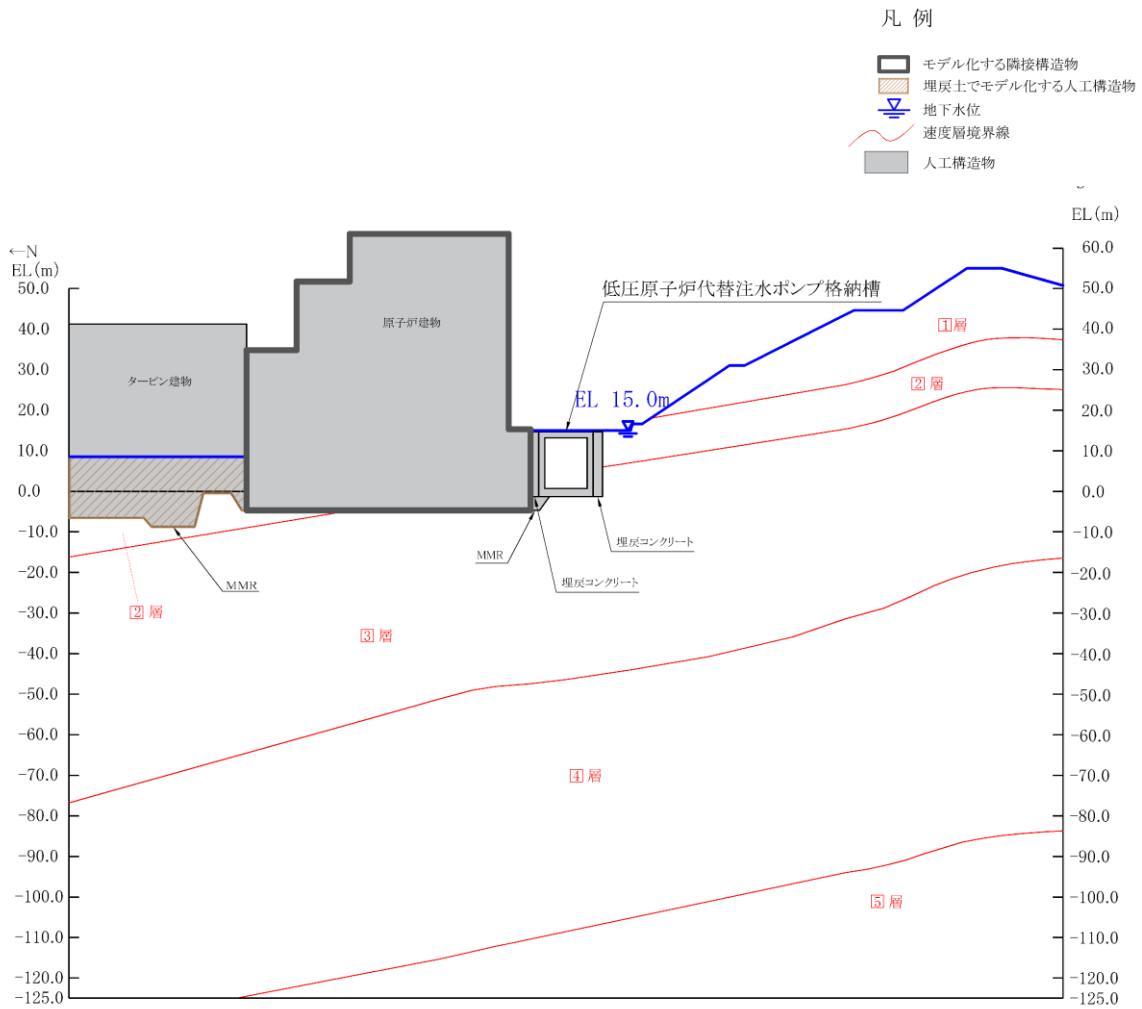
低圧原子炉代替注水ポンプ格納槽 断面図 (B-B 断面位置)
